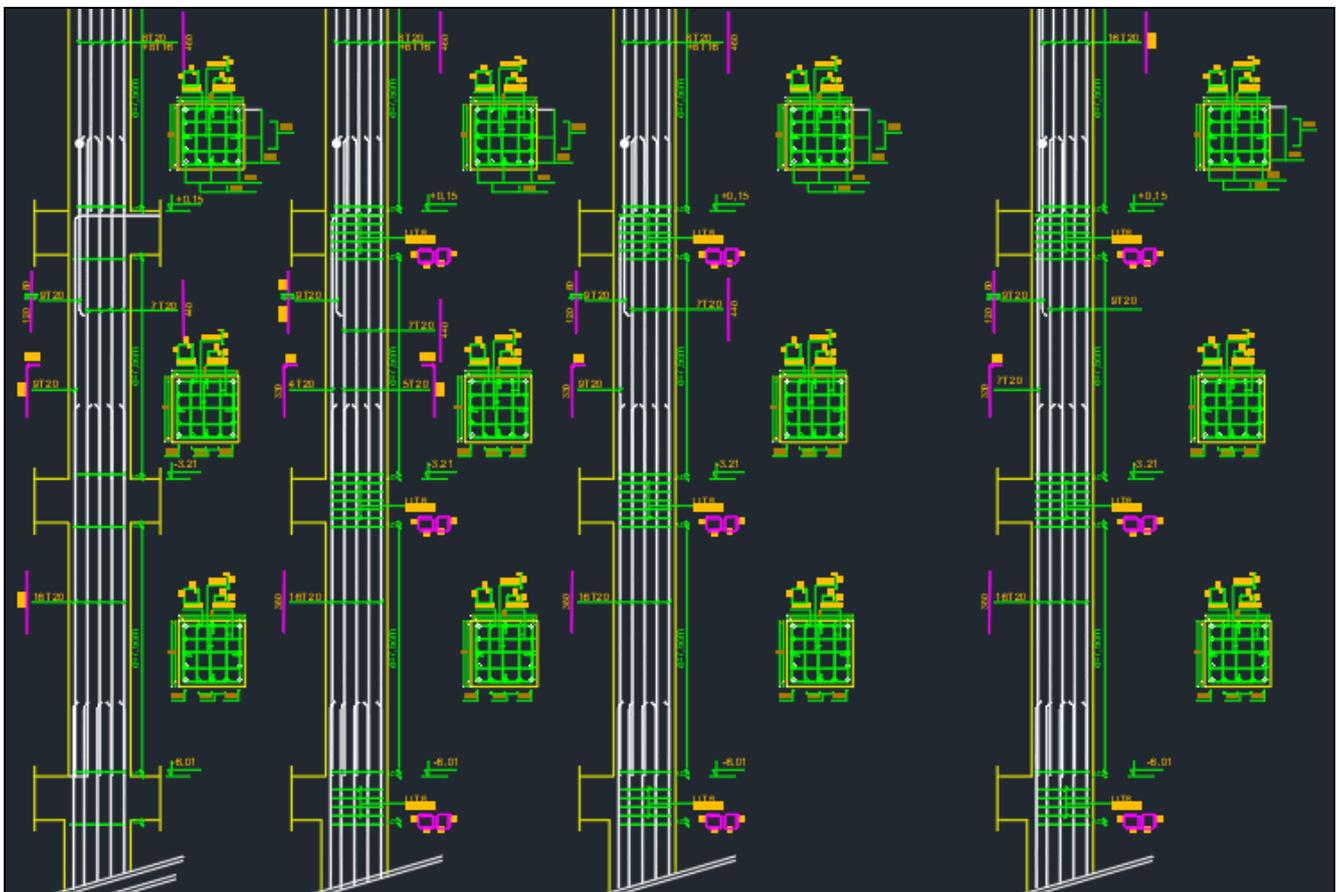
Plan de ferrailage des poteaux des premiers niveaux
